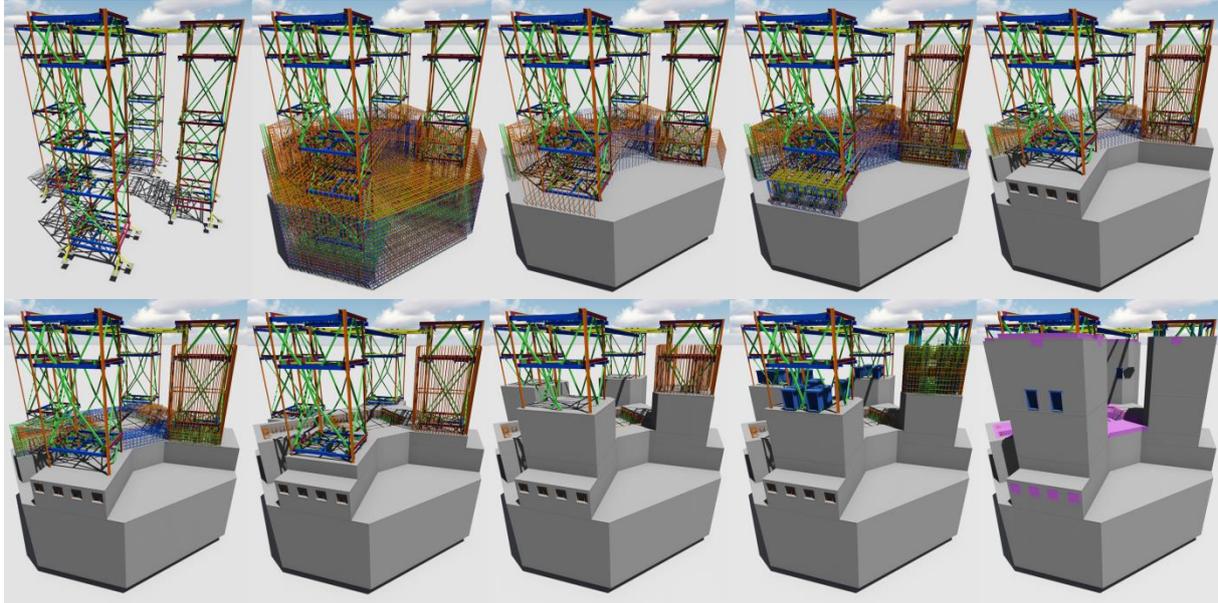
Faseamento construtivo utilizado durante uma reunião de coordenação.
